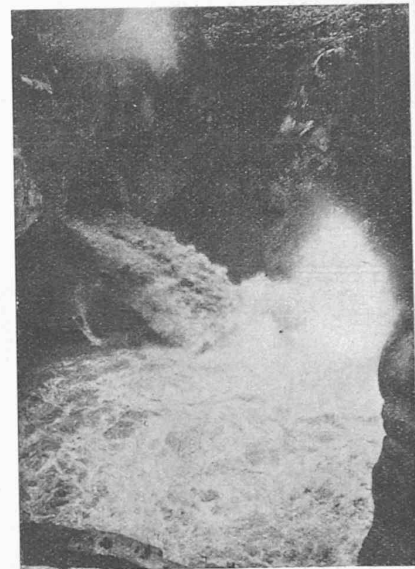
Tunnel-Ausmündung, gegen 100 m³/sek.
